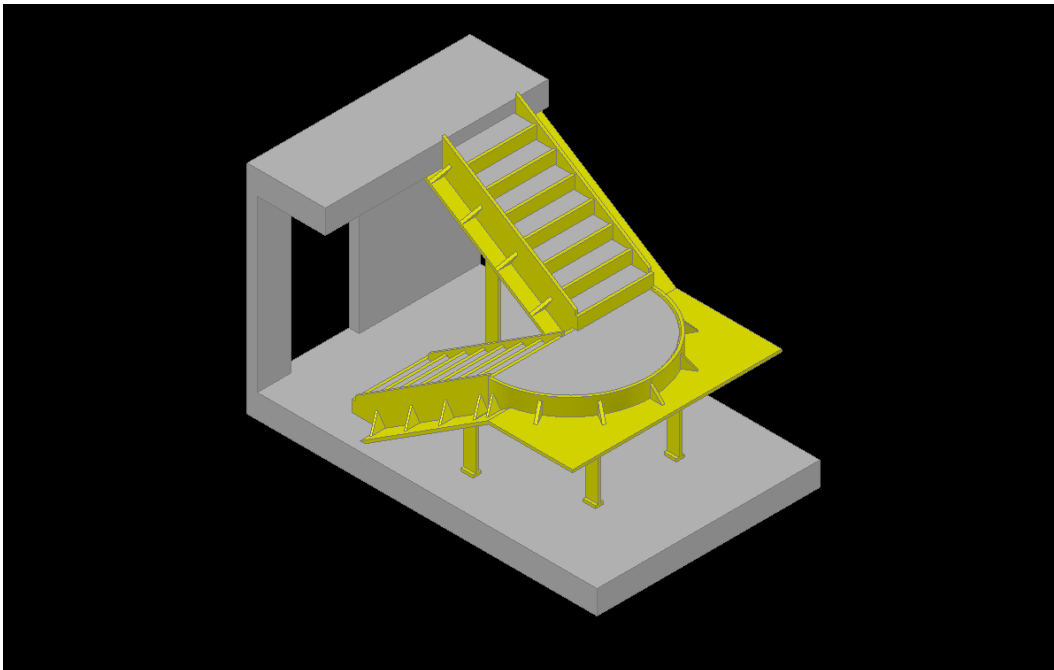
Ejecución de losa peldañeada de hormigón armado. Preparación para impresión en 3D.
